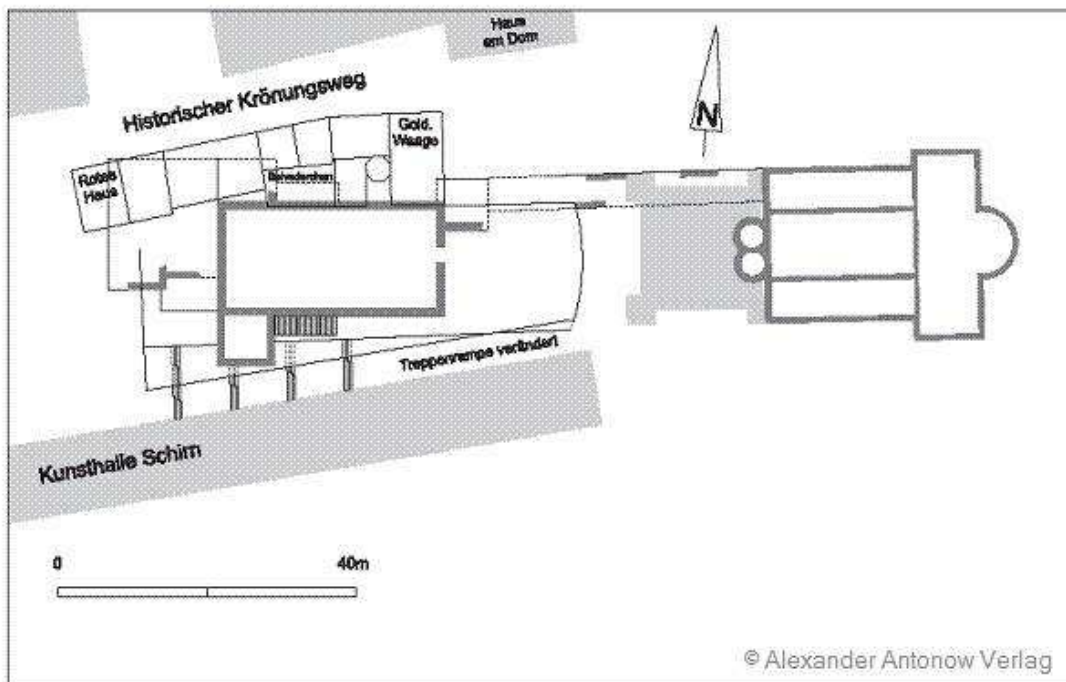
Wahrscheinlicher Grundriss der karolingischen Pfalzanlage mit den geplanten Altstadt-häusern und Schirm Kunsthalle in Frankfurt am Main.
